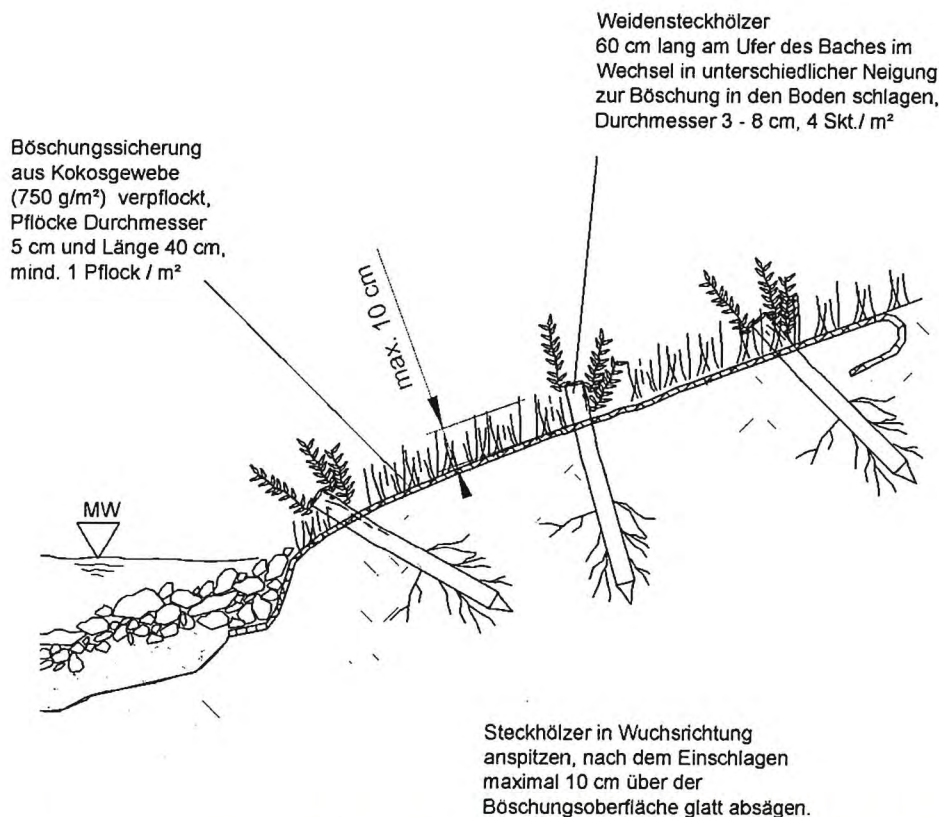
Regeldetail Begrünte Böschung mit Kokosgewebe sowie Stechhölzern und Bepflanzung
